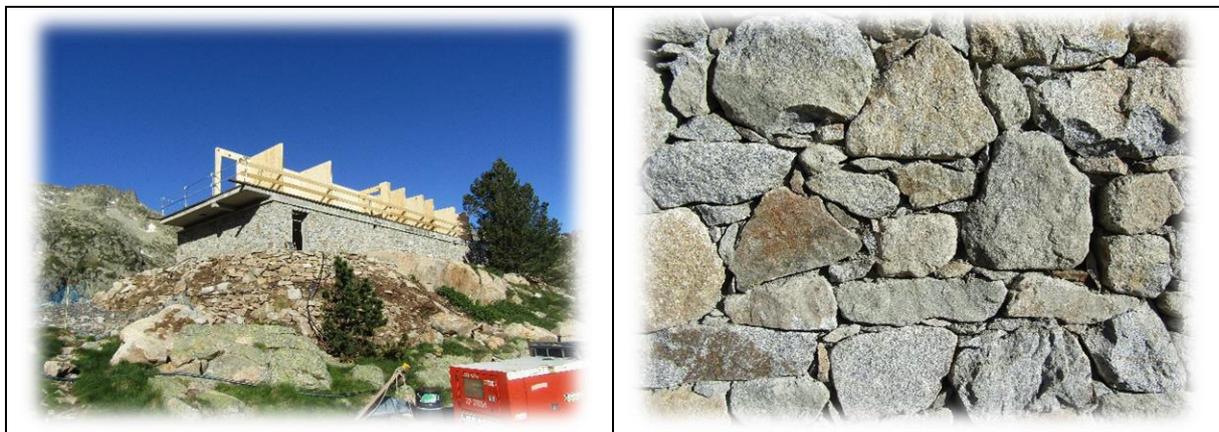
sous-bassement granitique – reconstruction du refuge de Campana de Cloutou
